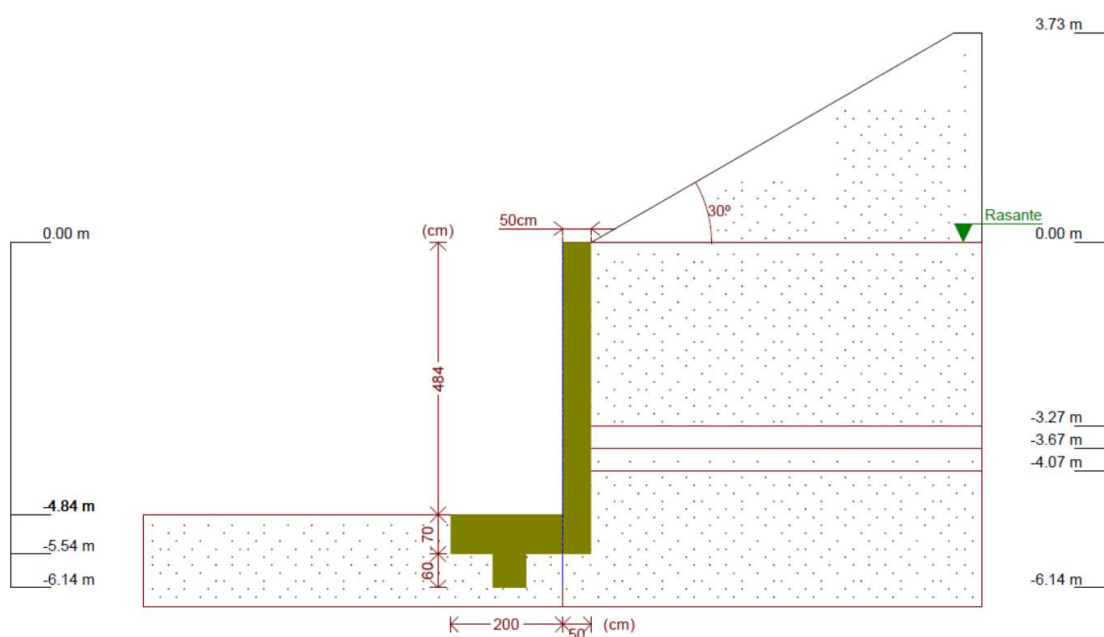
Modelo de muro de hormigón armado 3, para tramos de muro laterales con altura inferior a 4,84 m. Fuente: propia (elaborado con CYPE)
